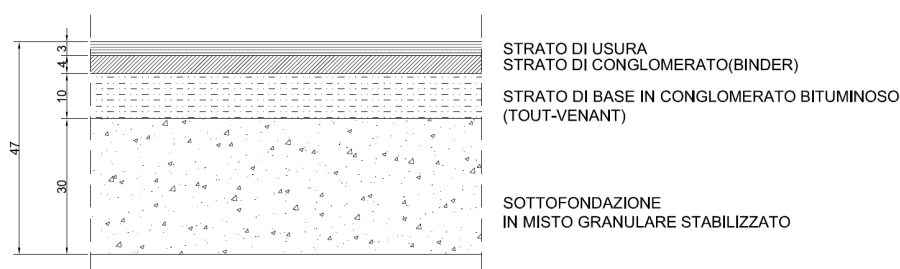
sezione tipo particolare pavimetnazione tratte di nuova ealizzazione e allargamenti sedimi stradali esistenti
